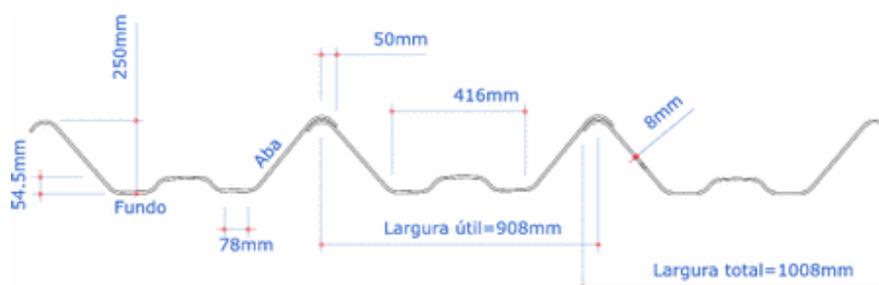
Telhas Canaleta 90 (Fonte: Eternit)
